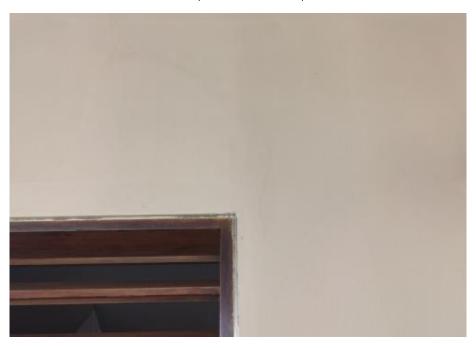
Fissura na parede externa do quarto do casal
